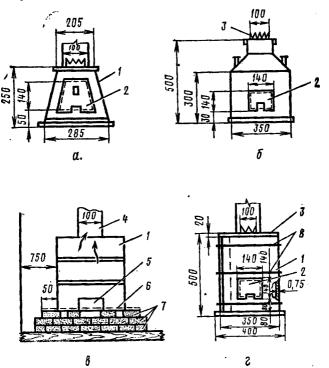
Печи, изготавливаемые войсками (размеры в мм): a — из ведра; b — из бидона; b — из металлической бочки; b — из кровельного железа; b — корпус; b — дверца; b — крышка с дымовым отверстиен; b — дымовая труба; b — топочное отверстие; b — металлическая решетка; b — основание из кирпича; b — скрутки из проводоки
